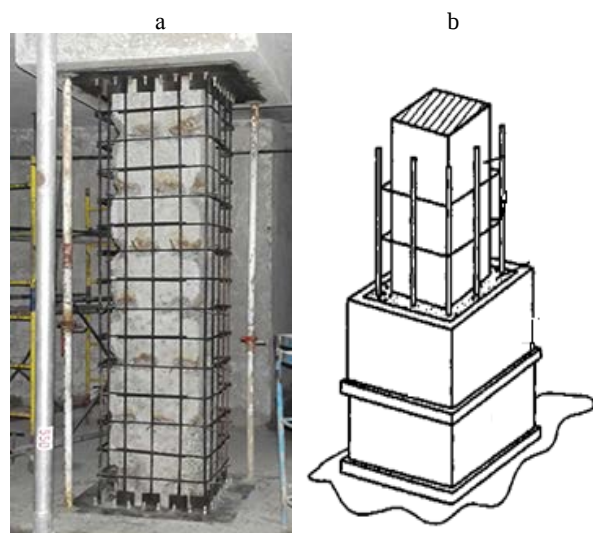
Восстановление железобетонной колонны с использованием технологии монолитной обоймы: а – дополнительное армирование; б – укладка ремонтной бетонной смеси в опалубку
